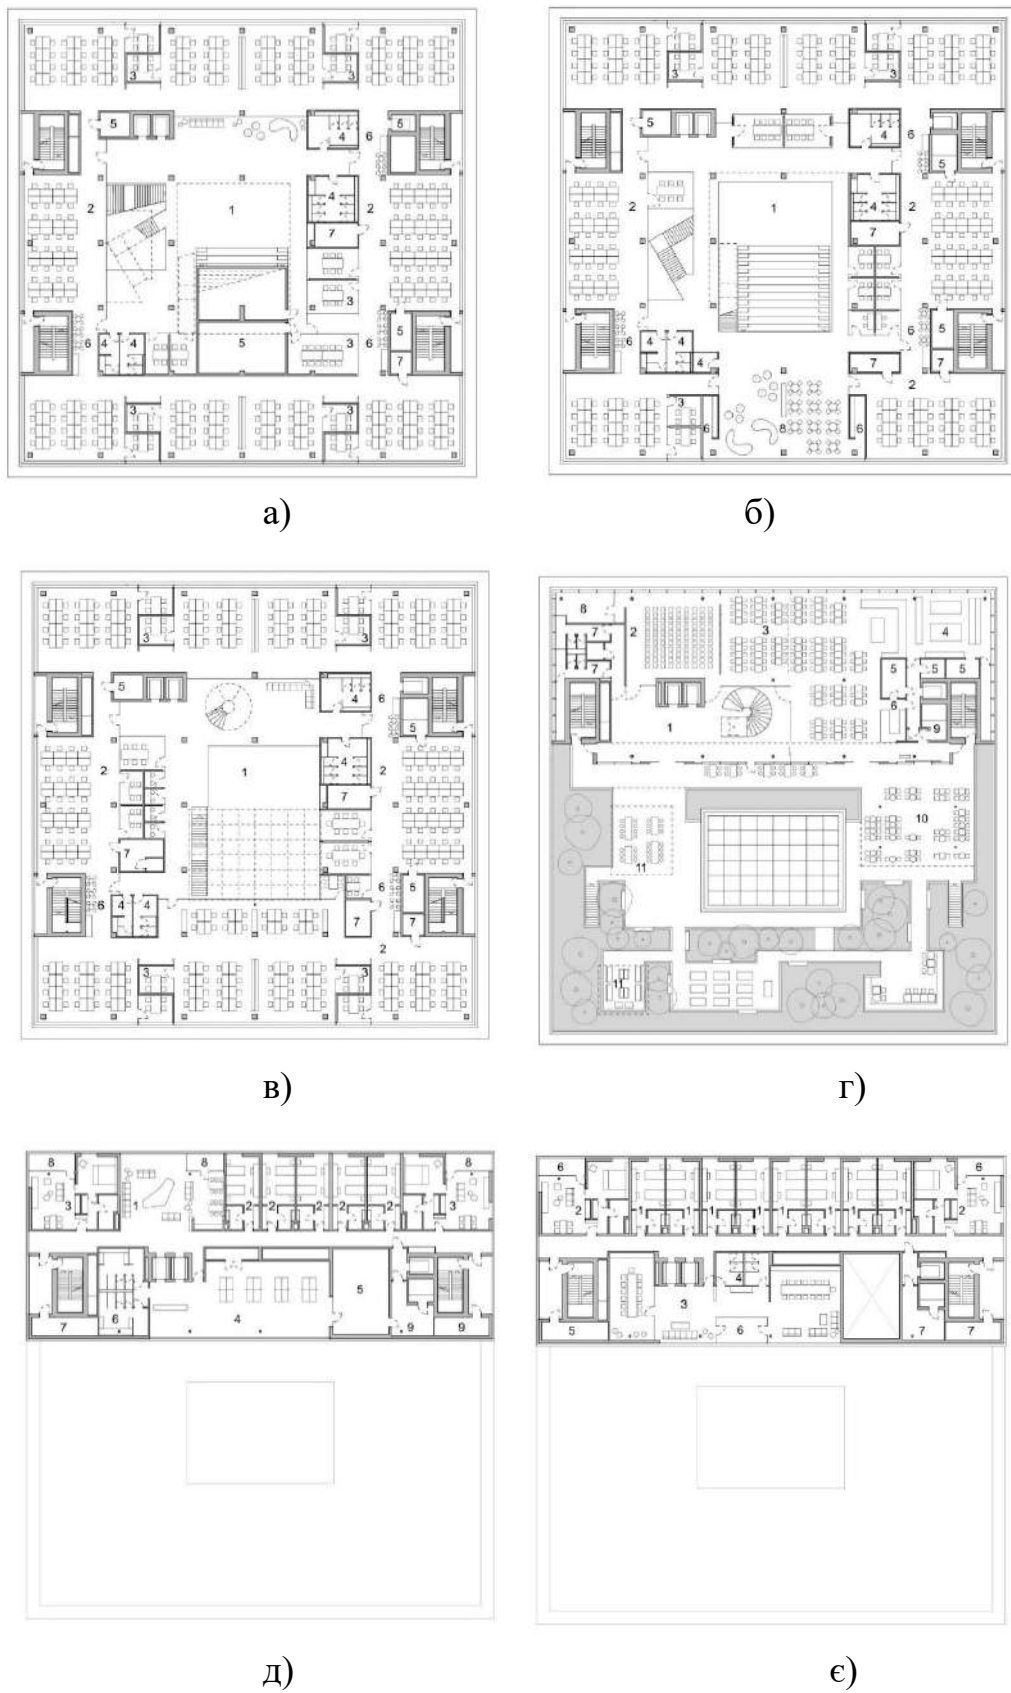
а) – план 1-го поверху; б) – план 2-го поверху; в) – план 3-го поверху; г) – план 4-го поверху; д) – план 5-го поверху; е) – план 6-го поверху.
